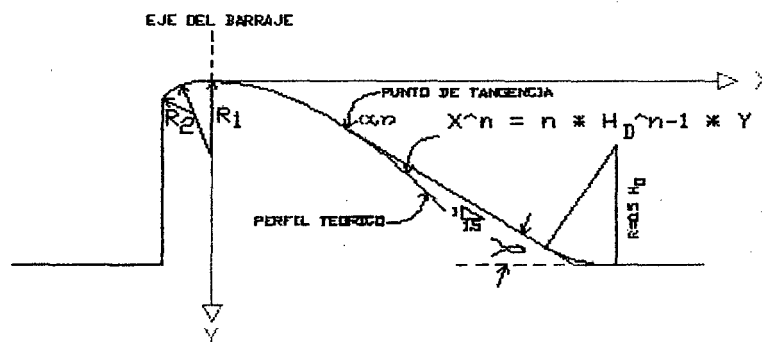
PERFIL DEL BARRAJE VERTEDERO SUGERIDO
